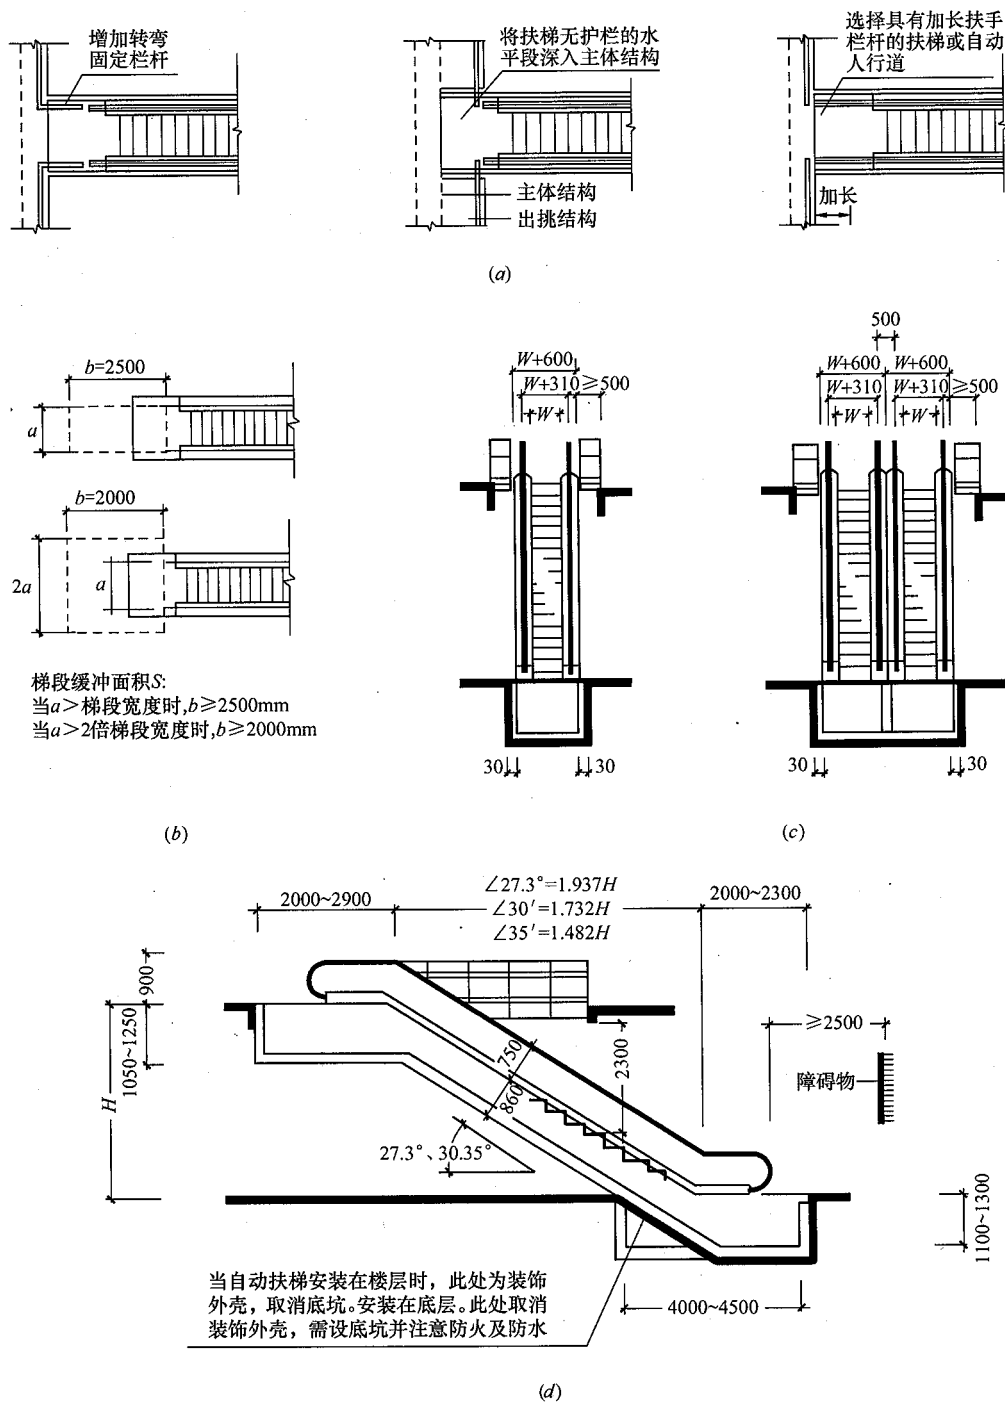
自动扶梯平、立、剖面图 (单位: mm)
